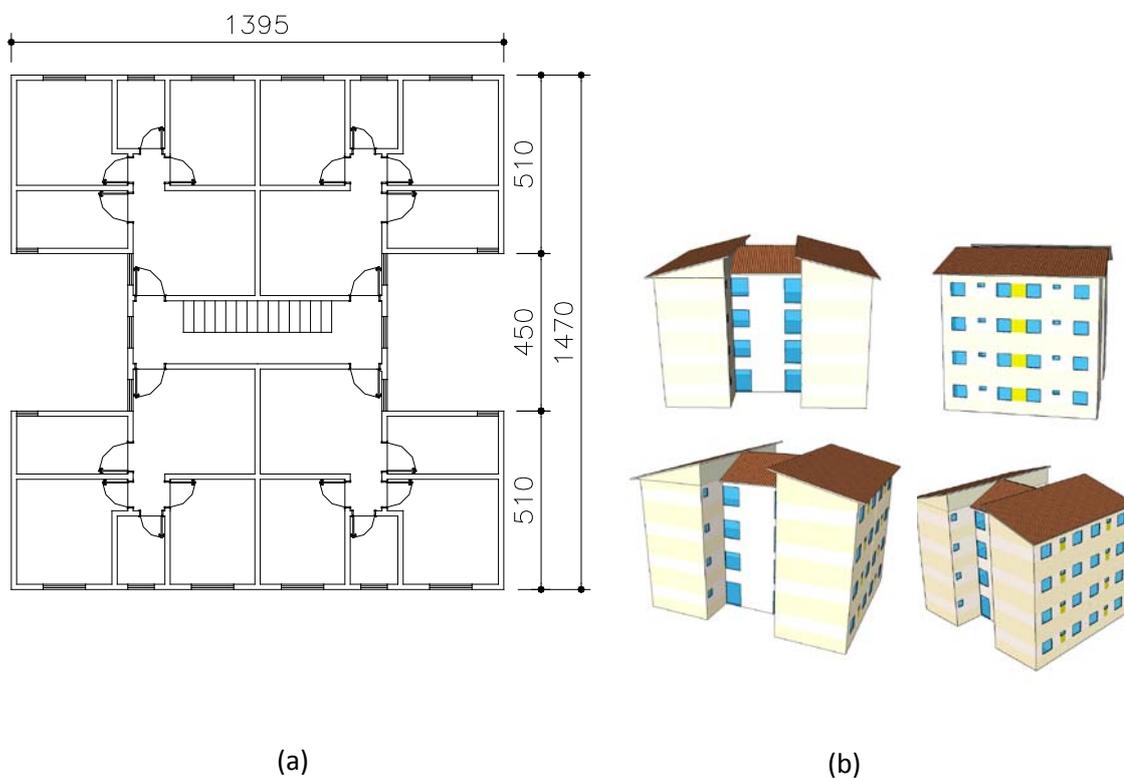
Projeto adotado: (a) Planta do pavimento típico e (b) perspectivas.
